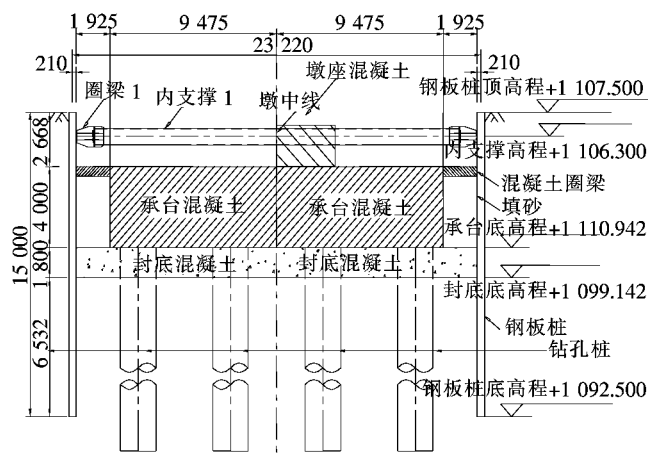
13# 墩围堰立面图(除标高单位为 m 外,其余单位:mm)
